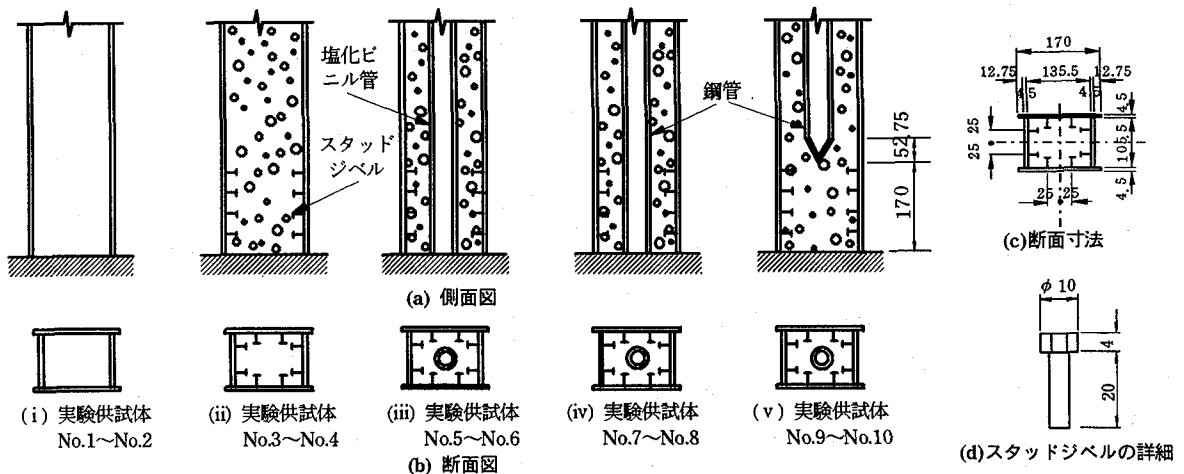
実験供試体の側面図、および断面図 (寸法単位:mm)
